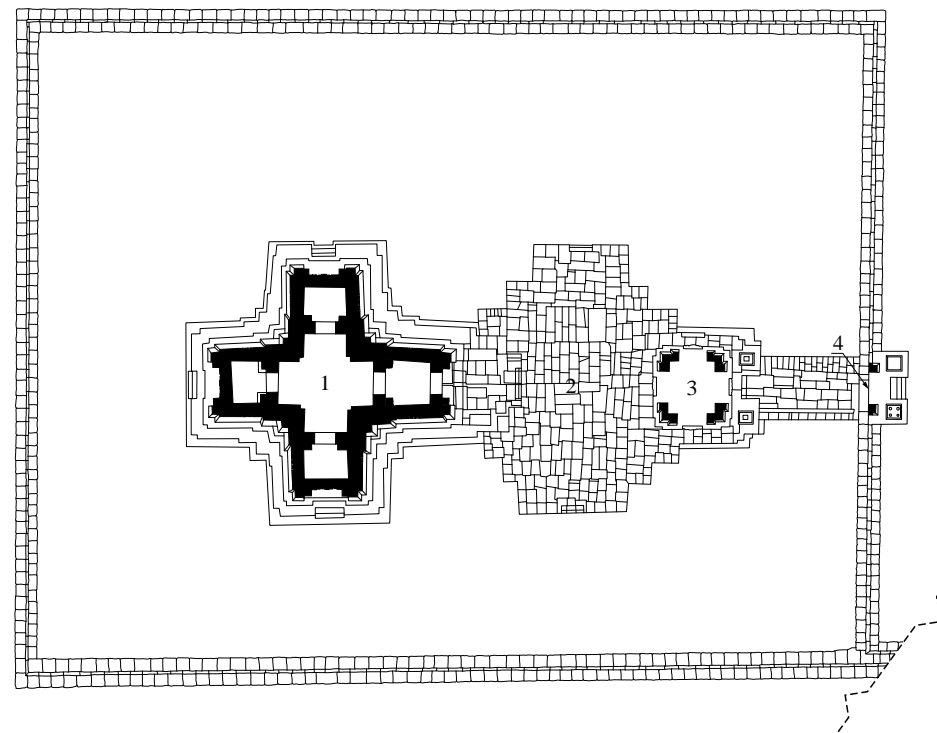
Plan du Prasat Chrung Sud-Ouest d'Angkor Thom
